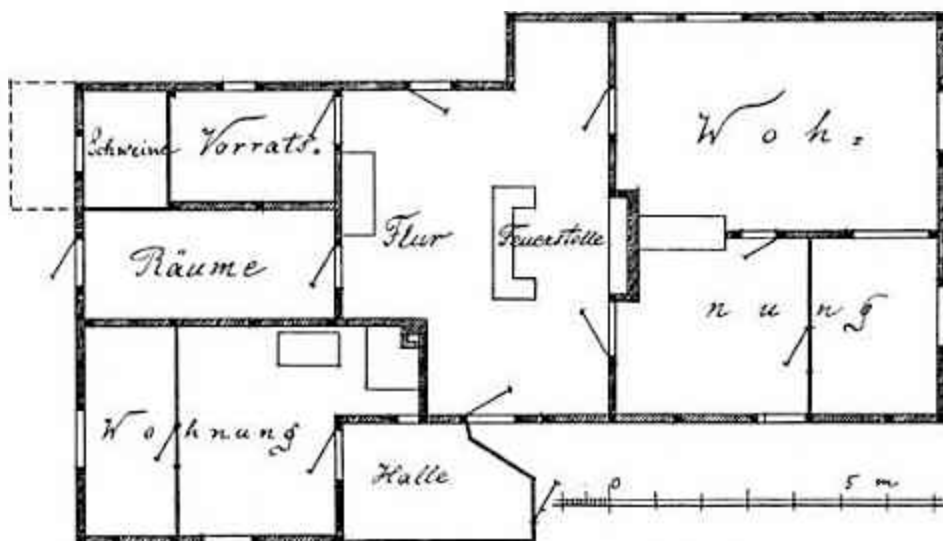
Grundriss eines litauischen Hauses (Inse).
